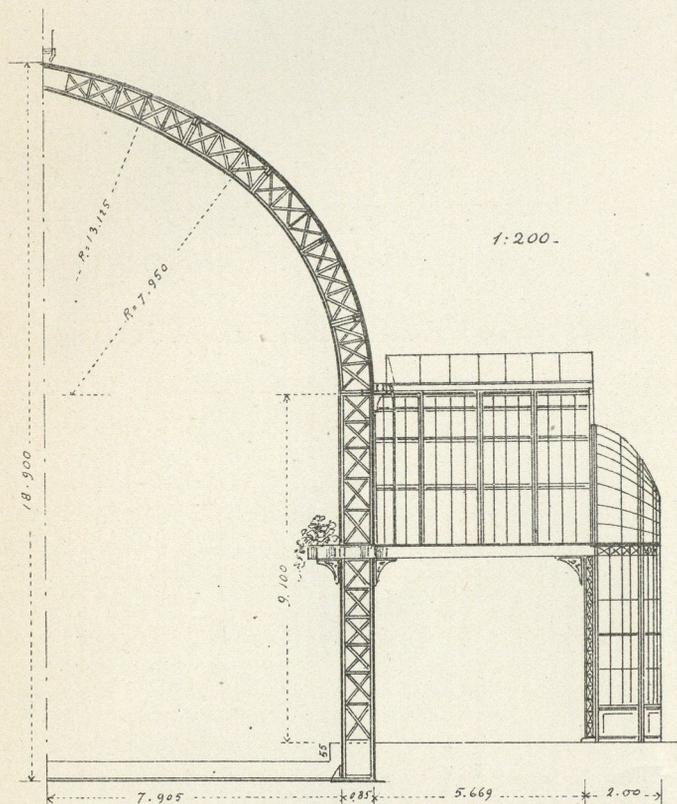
Sezione trasversale del Palazzo dell'Orticoltura.
